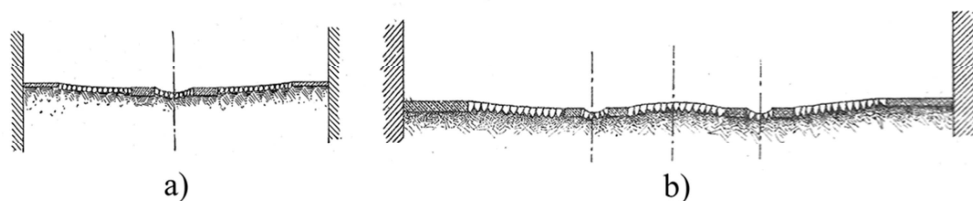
Sezione trasversale di un acciottolato misto: a) pavimentazione con una sola coppia di binari [105] e b) pavimentazione con due coppie di binari [99].
